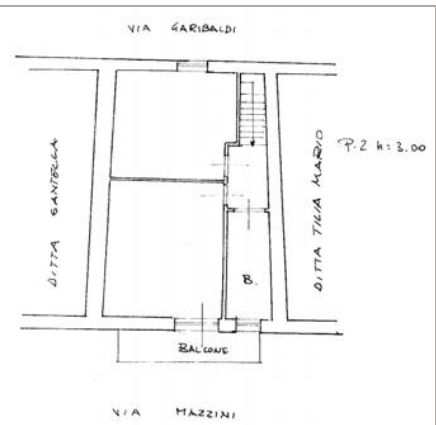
planimetria catastale Fg.10 Part.614 Sub.2 (abitazione - Piano Secondo)
